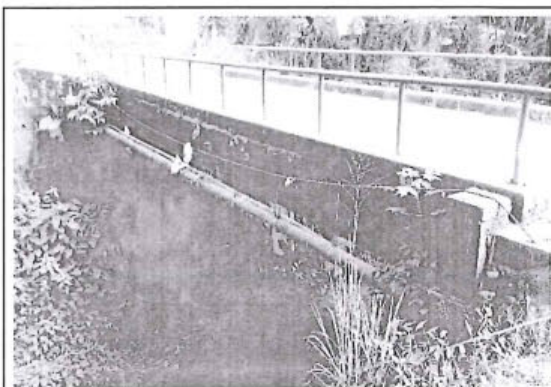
Vista aguas abajo del Puente Viga losa de L=10.80m en estado bueno, ubicado en la progresiva km 1+912.
